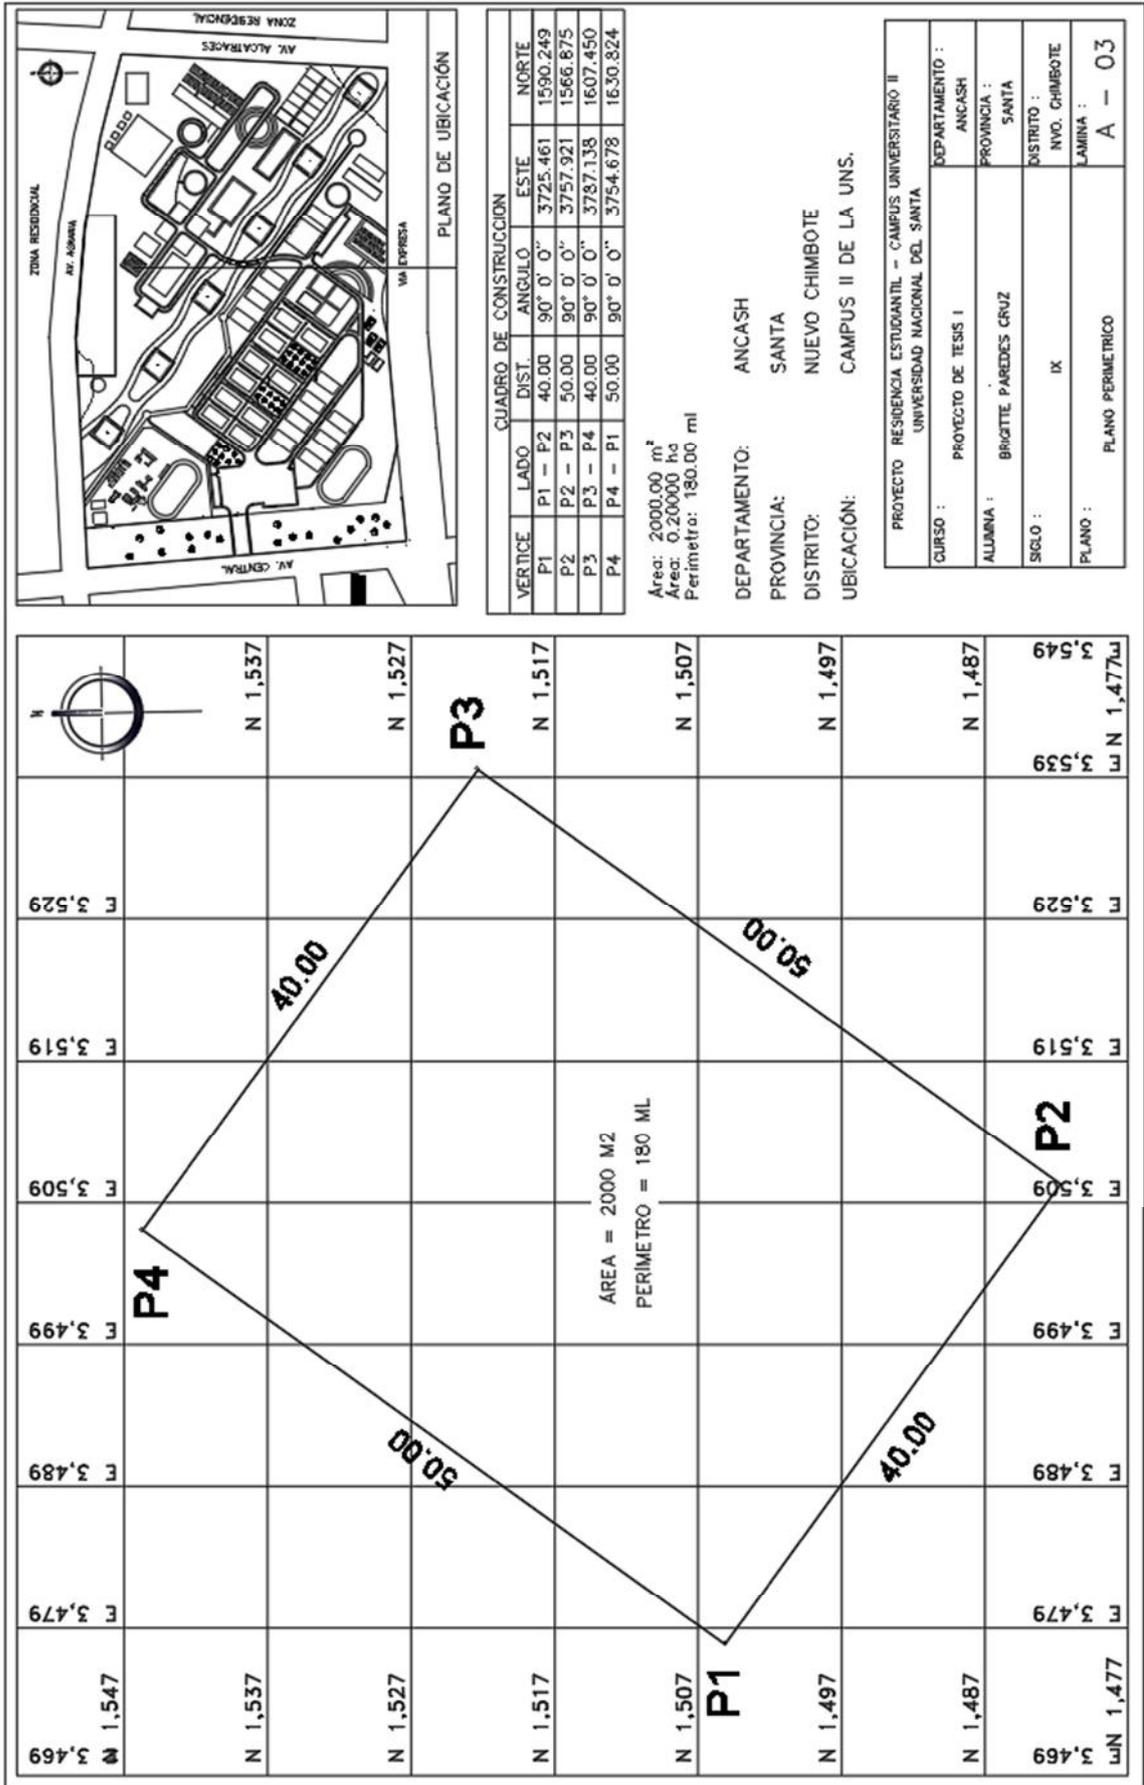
Plano Ubicación– Campus II – Residencia Estudiantil.
